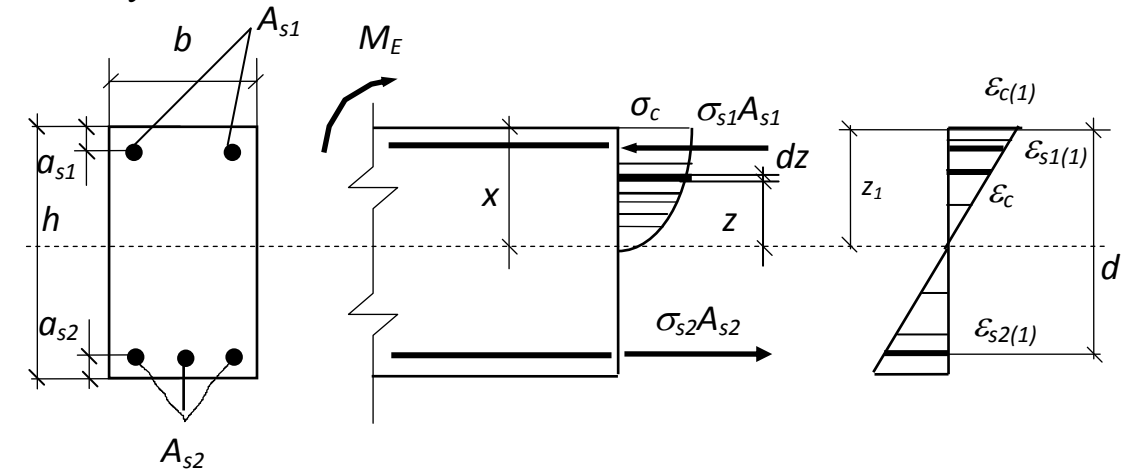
Напряженно-деформированное состояние прямоугольного сечения с двойной арматурой
